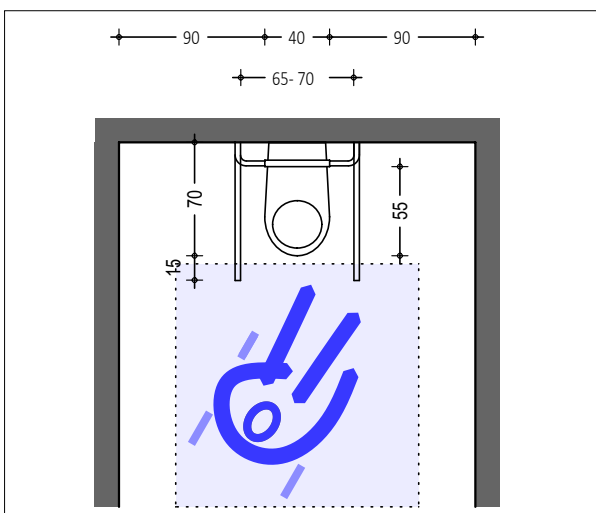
WC-Grundriss - Mindestabmessungen und Bewegungsflächen II
